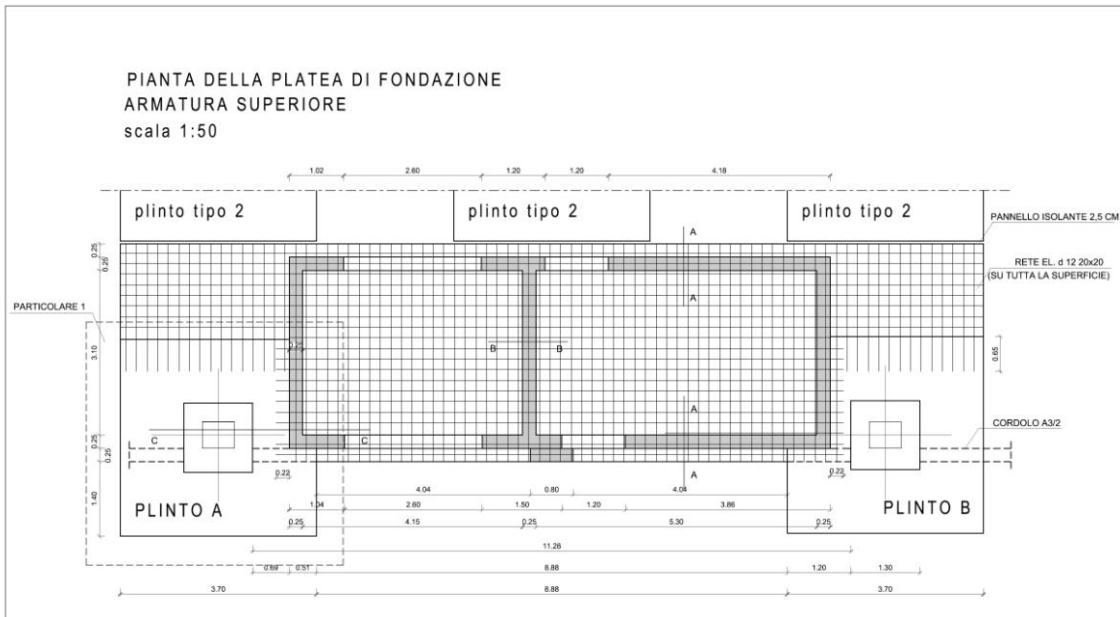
Particolare di A.2003.cap.us.T03 - Particolari fondazione nucleo 3 - Pianta platea
